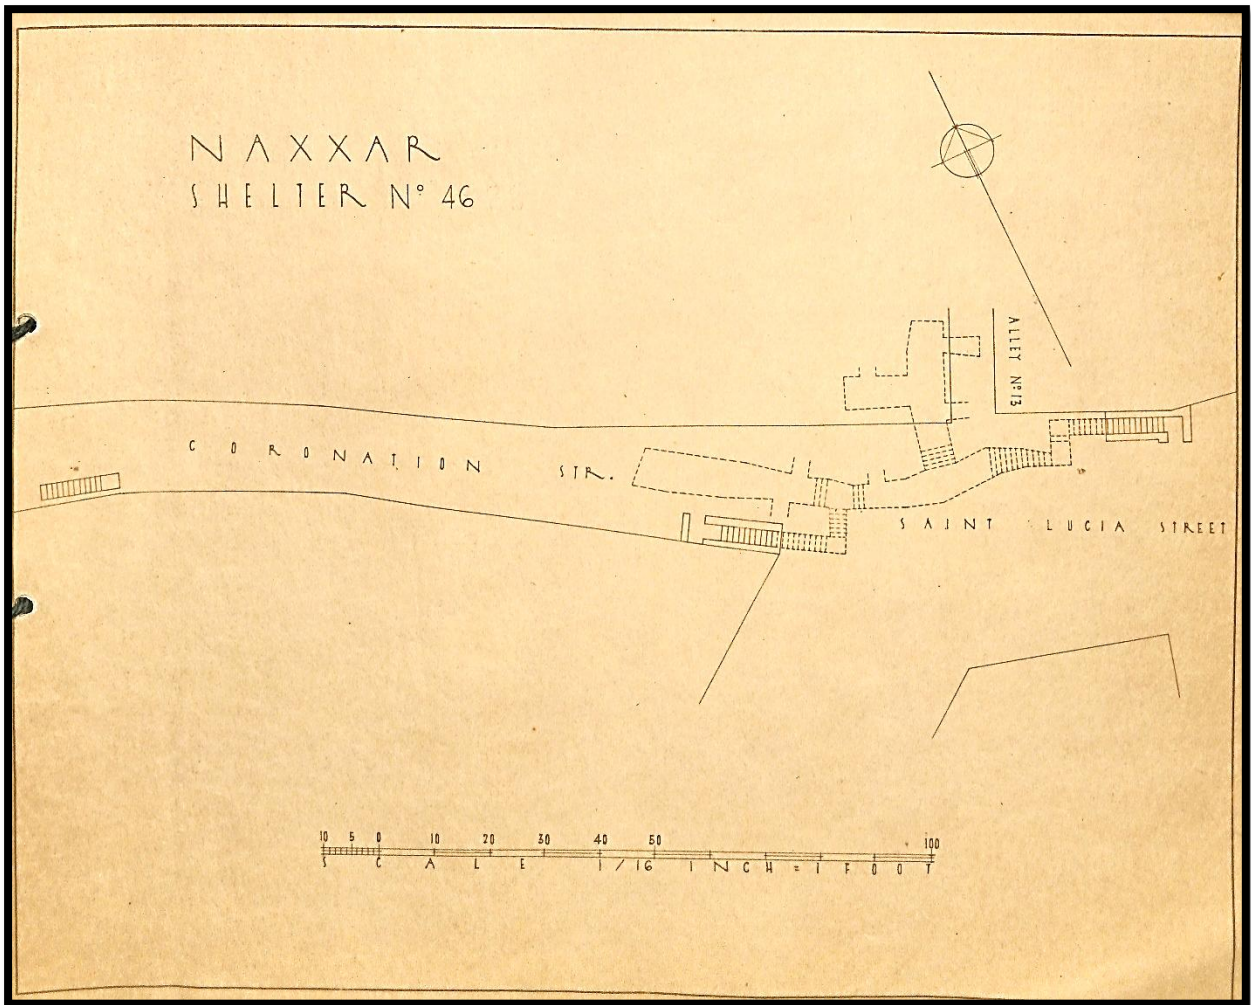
Planta do Abrigo nº46 (23) "Coronation Str*. – Aley nº13 – Saint Lucia Street"
